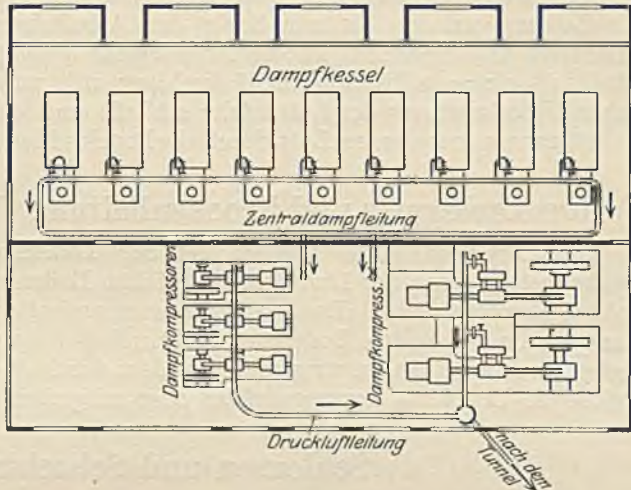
Druckluftherzeugung mit Dampfkompressorenanlage (Elbtunnel Hamburg).
